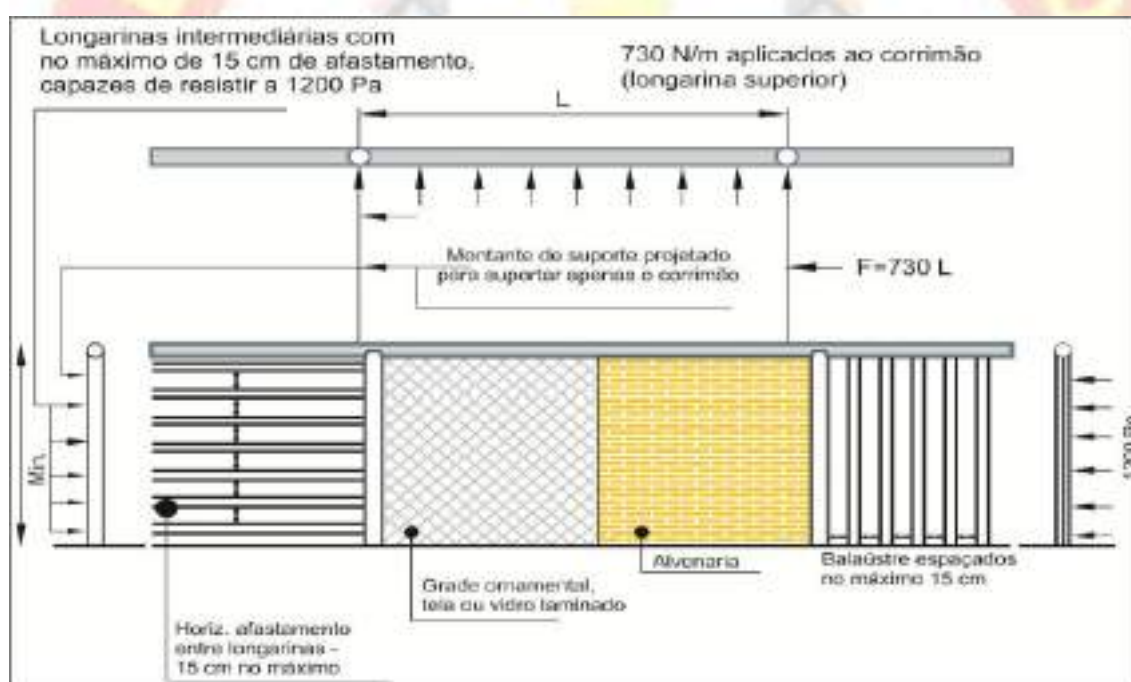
Pormenores construtivos da instalação de guardas e as cargas a que elas devem resistir
